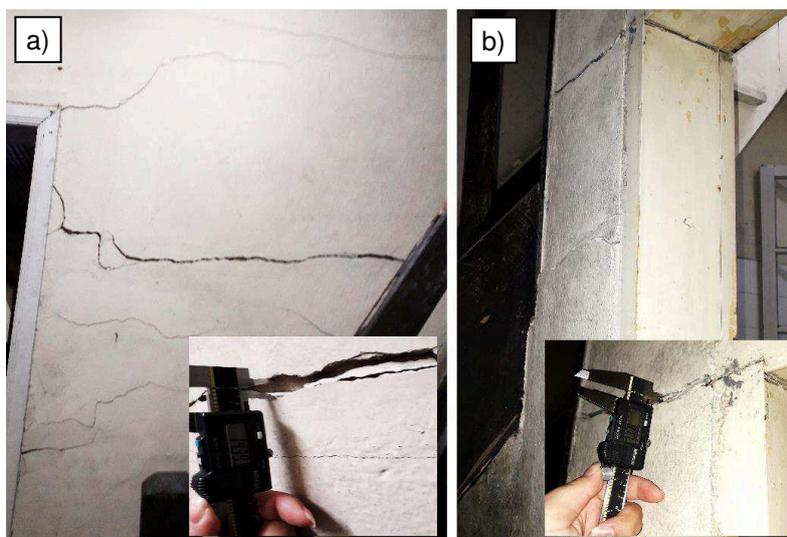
Fissuras no 1º pavimento: (a) no ponto F3; (b) no ponto F4
